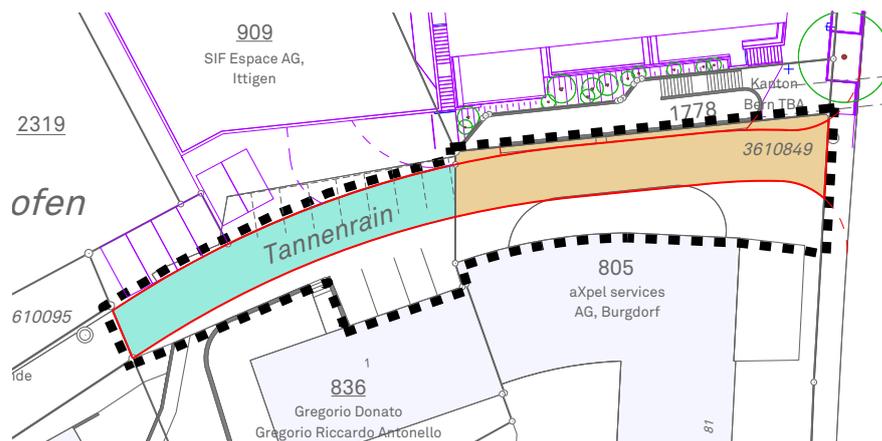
Ausschnitt Landerwerksplan mit durch dauerhaftem Landerwerb betroffenen Parzellen Nrn. 805 und 836 (nicht massstäblich)
